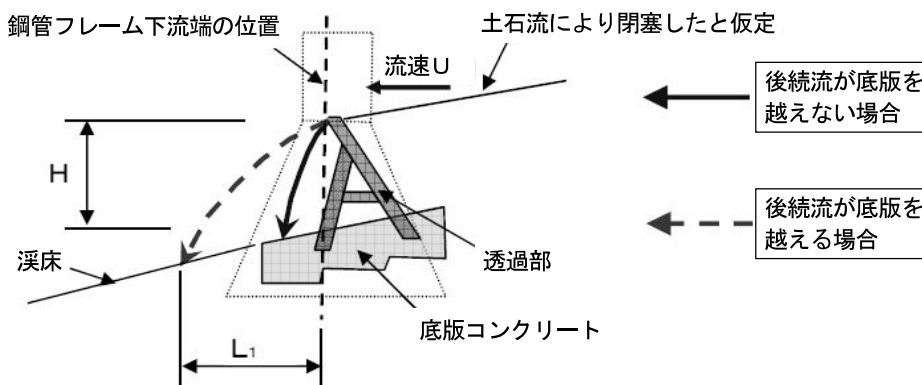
透過型砂防堰堤の後続流の落下位置
